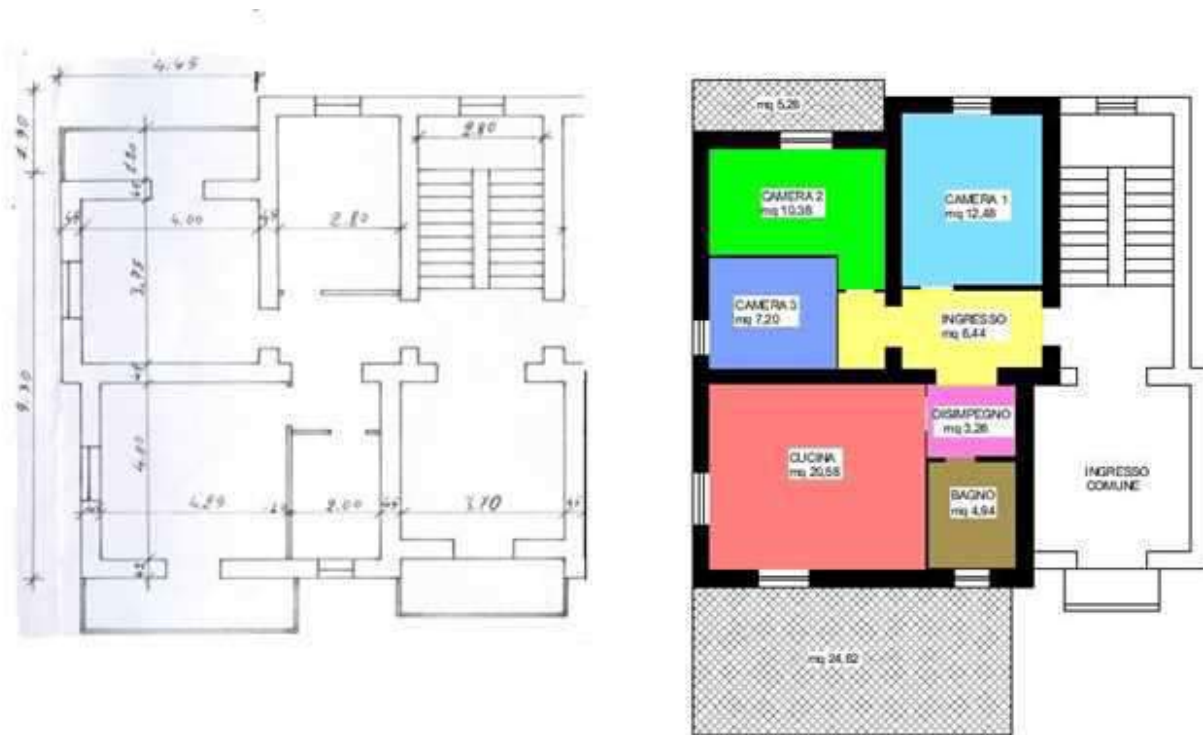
Sovrapposizione tra lo stato di fatto e il progetto assentito
